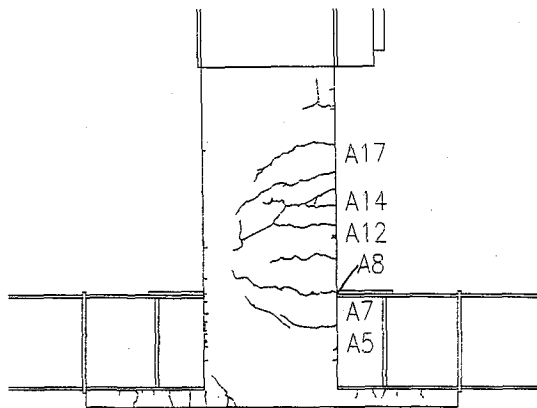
TYPE 1-2 1.0 δ_y 載荷時橋脚ひび割れ図
